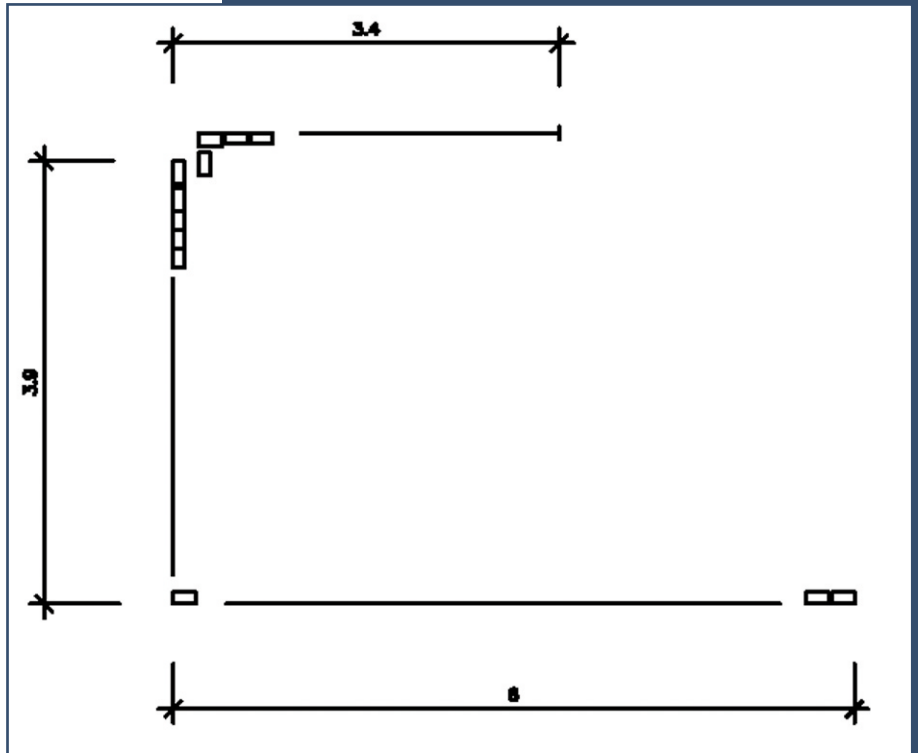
Grundriss der vermutlichen Pieranlage
